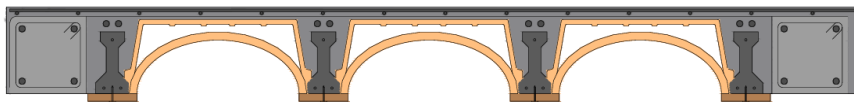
Detalle forjado con revoltón cerámico. 2024. Fuente: Propia
